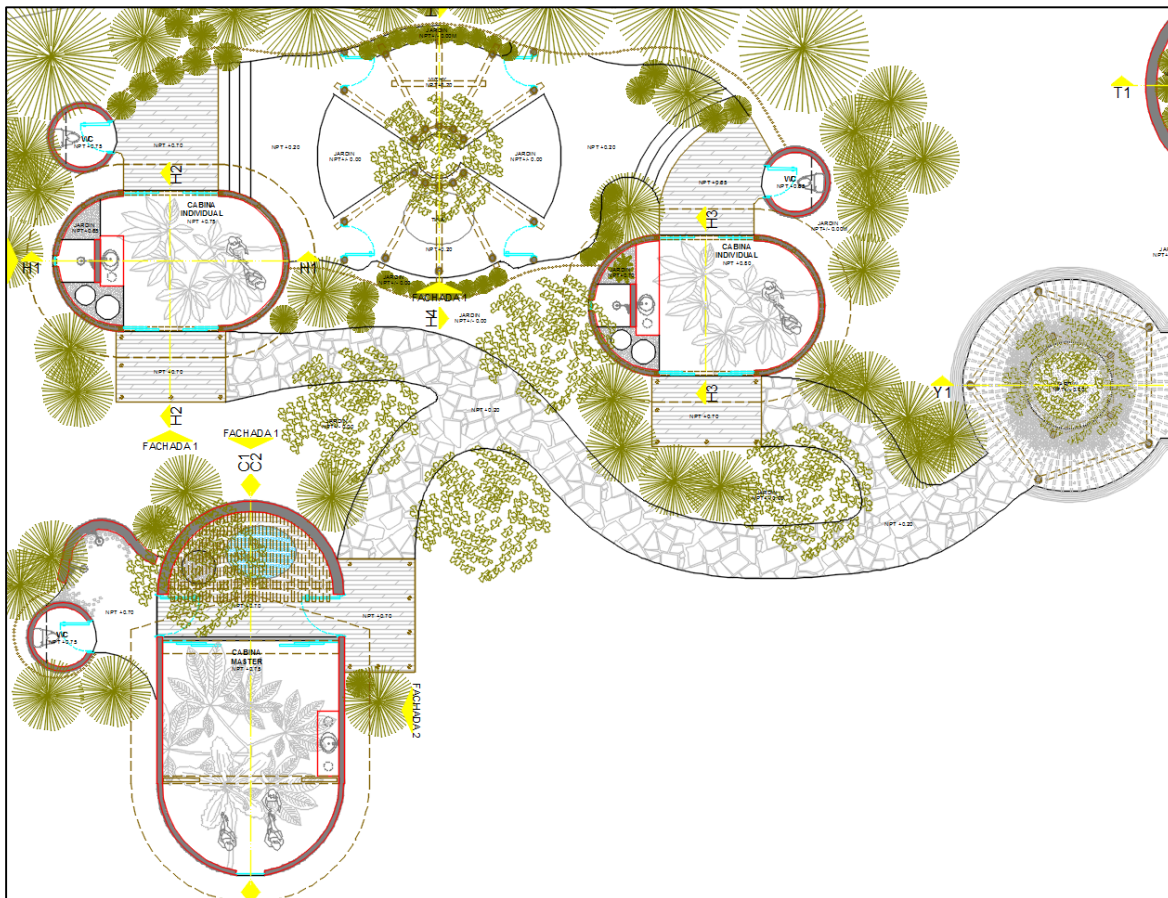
Planta arquitectónica de las Cabinas del módulo de SPA.
